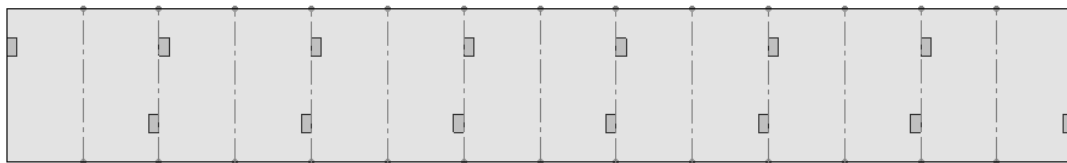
Vista de planta de la distribución 2 de los aires acondicionados.
